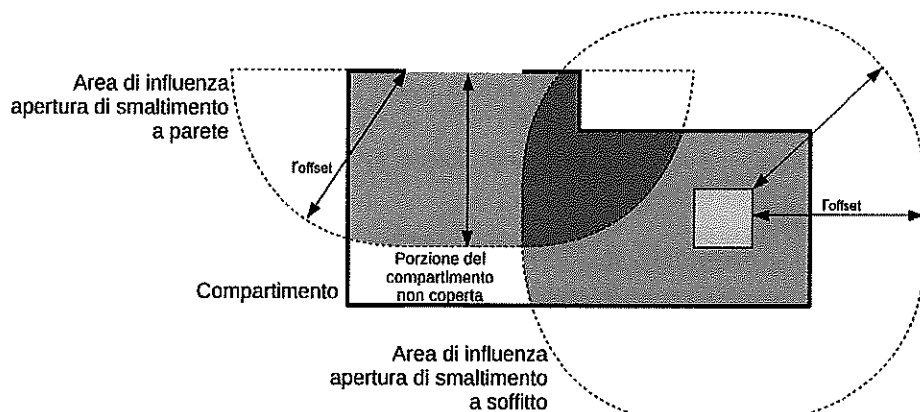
Verifica dell'uniforme distribuzione in pianta delle aperture di smaltimento
